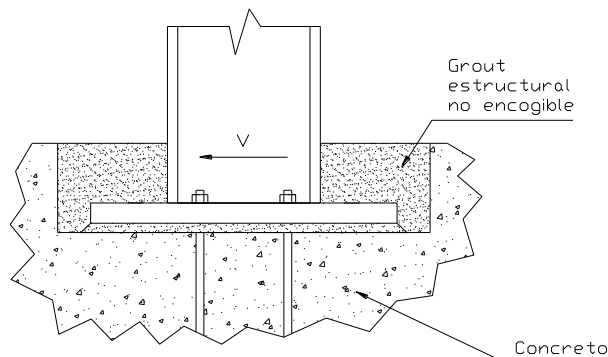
Detalle del Incrustado de la Columna a la Fundación.
